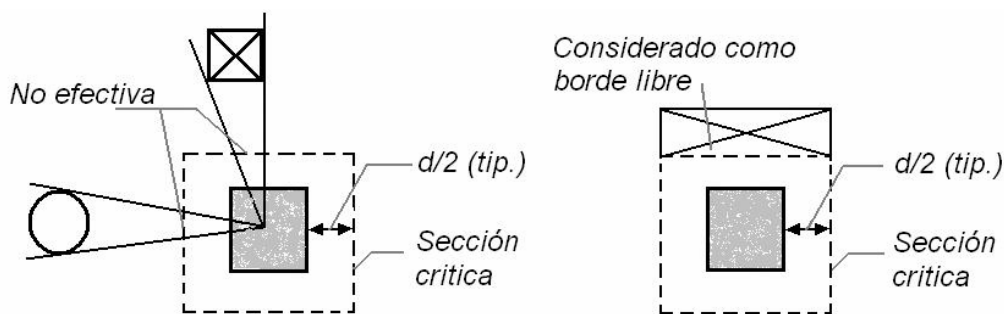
Efectos de las aberturas en la losa. Adaptado de Essential Requirements for Reinforced Concrete Buildings¹.
